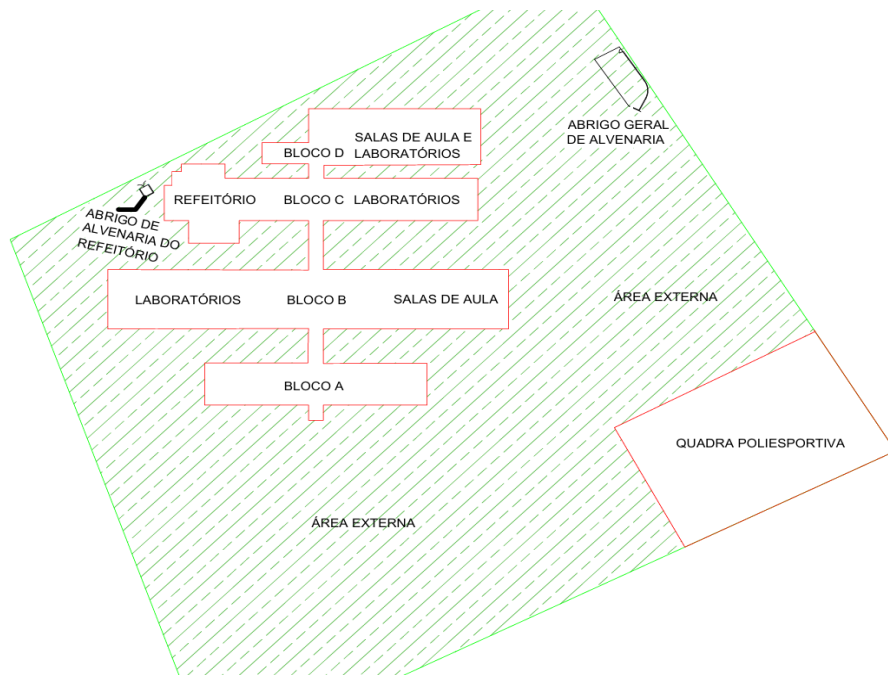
Acesso as áreas internas do IFPI – Campus Teresina Zona Sul.
